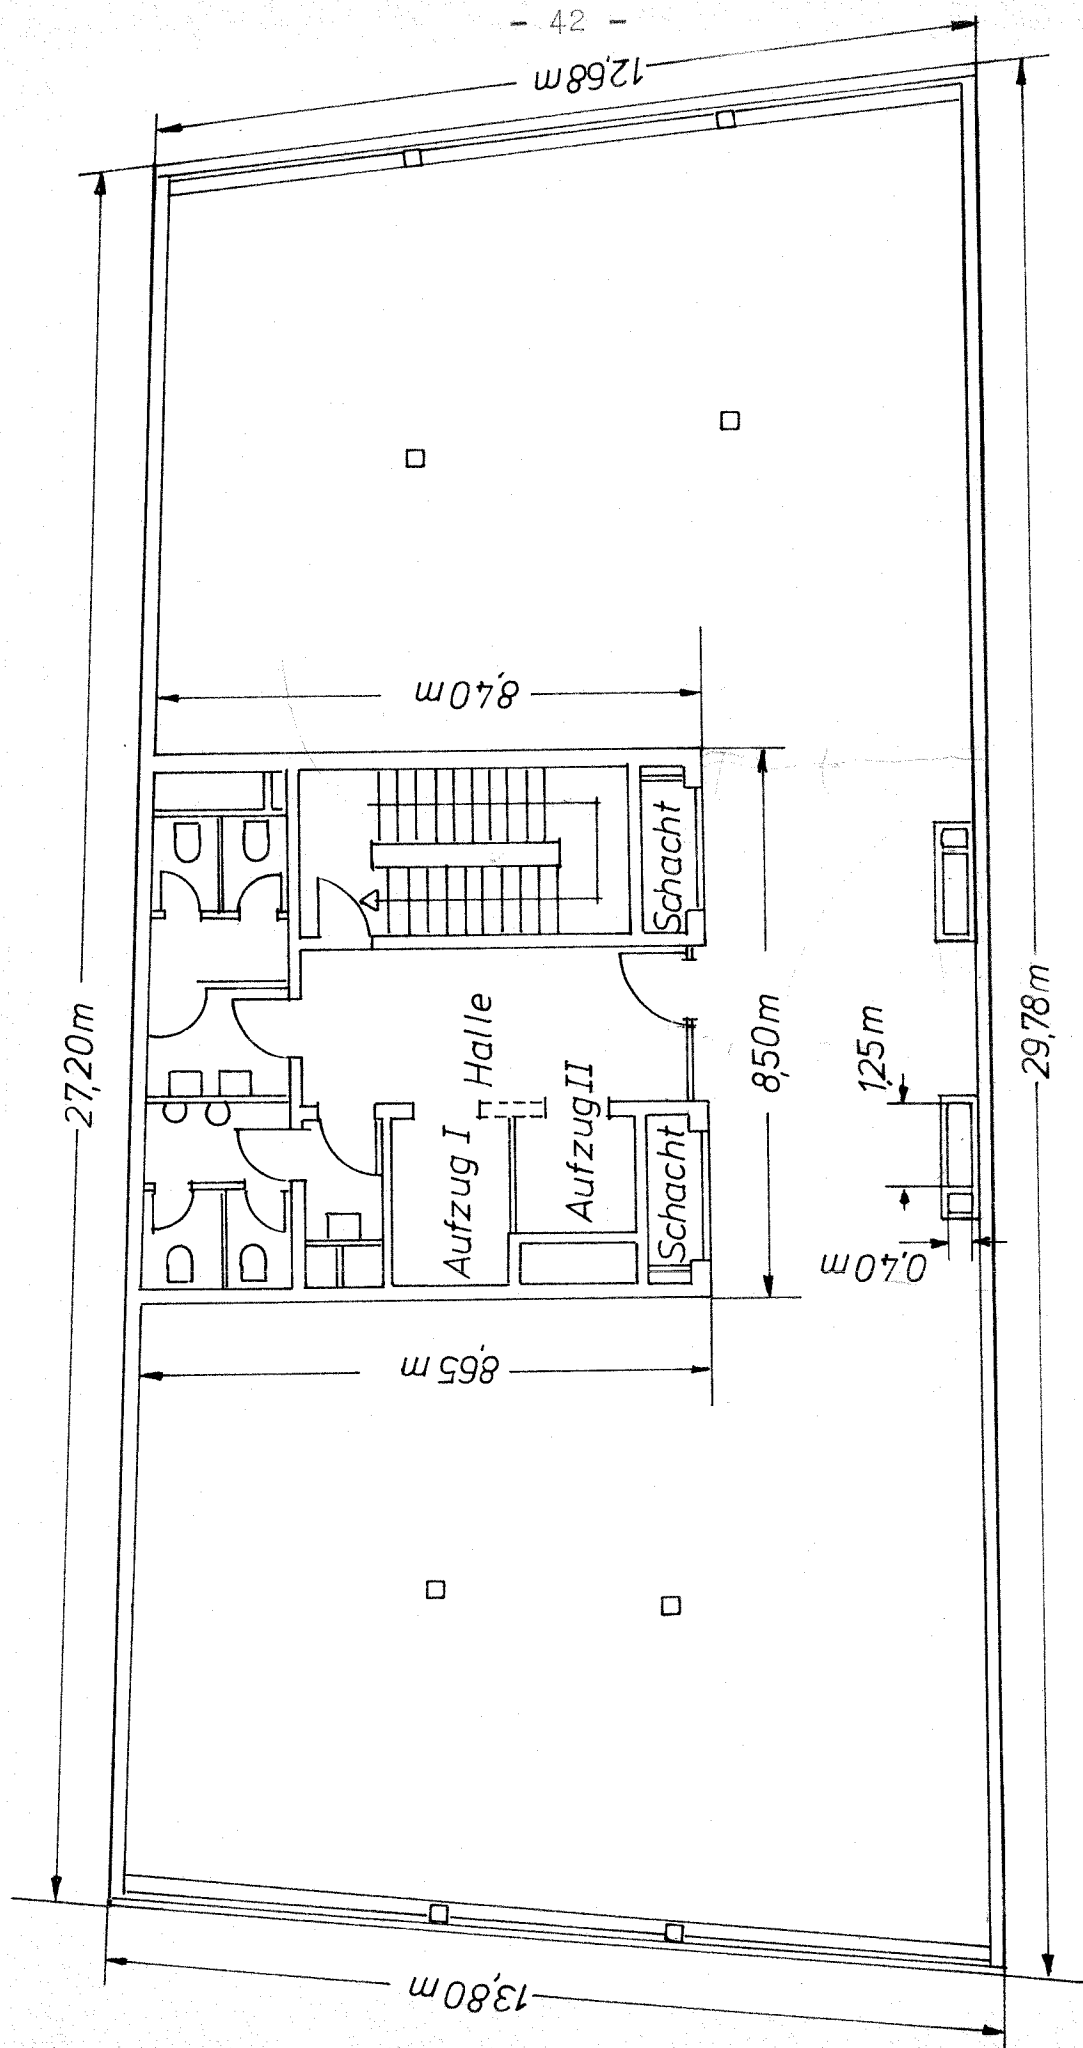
Grundriß eines Normalgeschosses im Gebäude Großer Burstah 46-48
